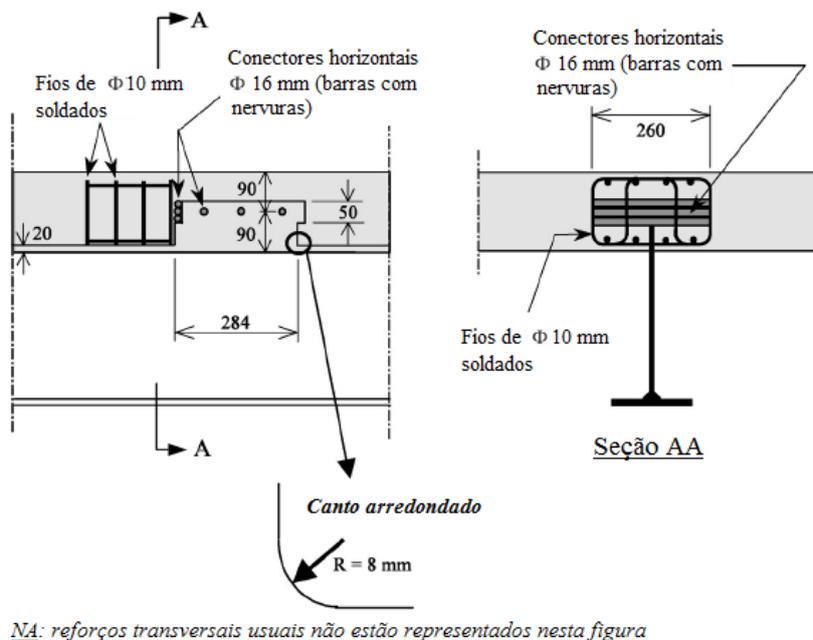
Conector de barras horizontais soldados a alma recortada do perfil metálico (Jurkiewicz e Hottier, 2005)
